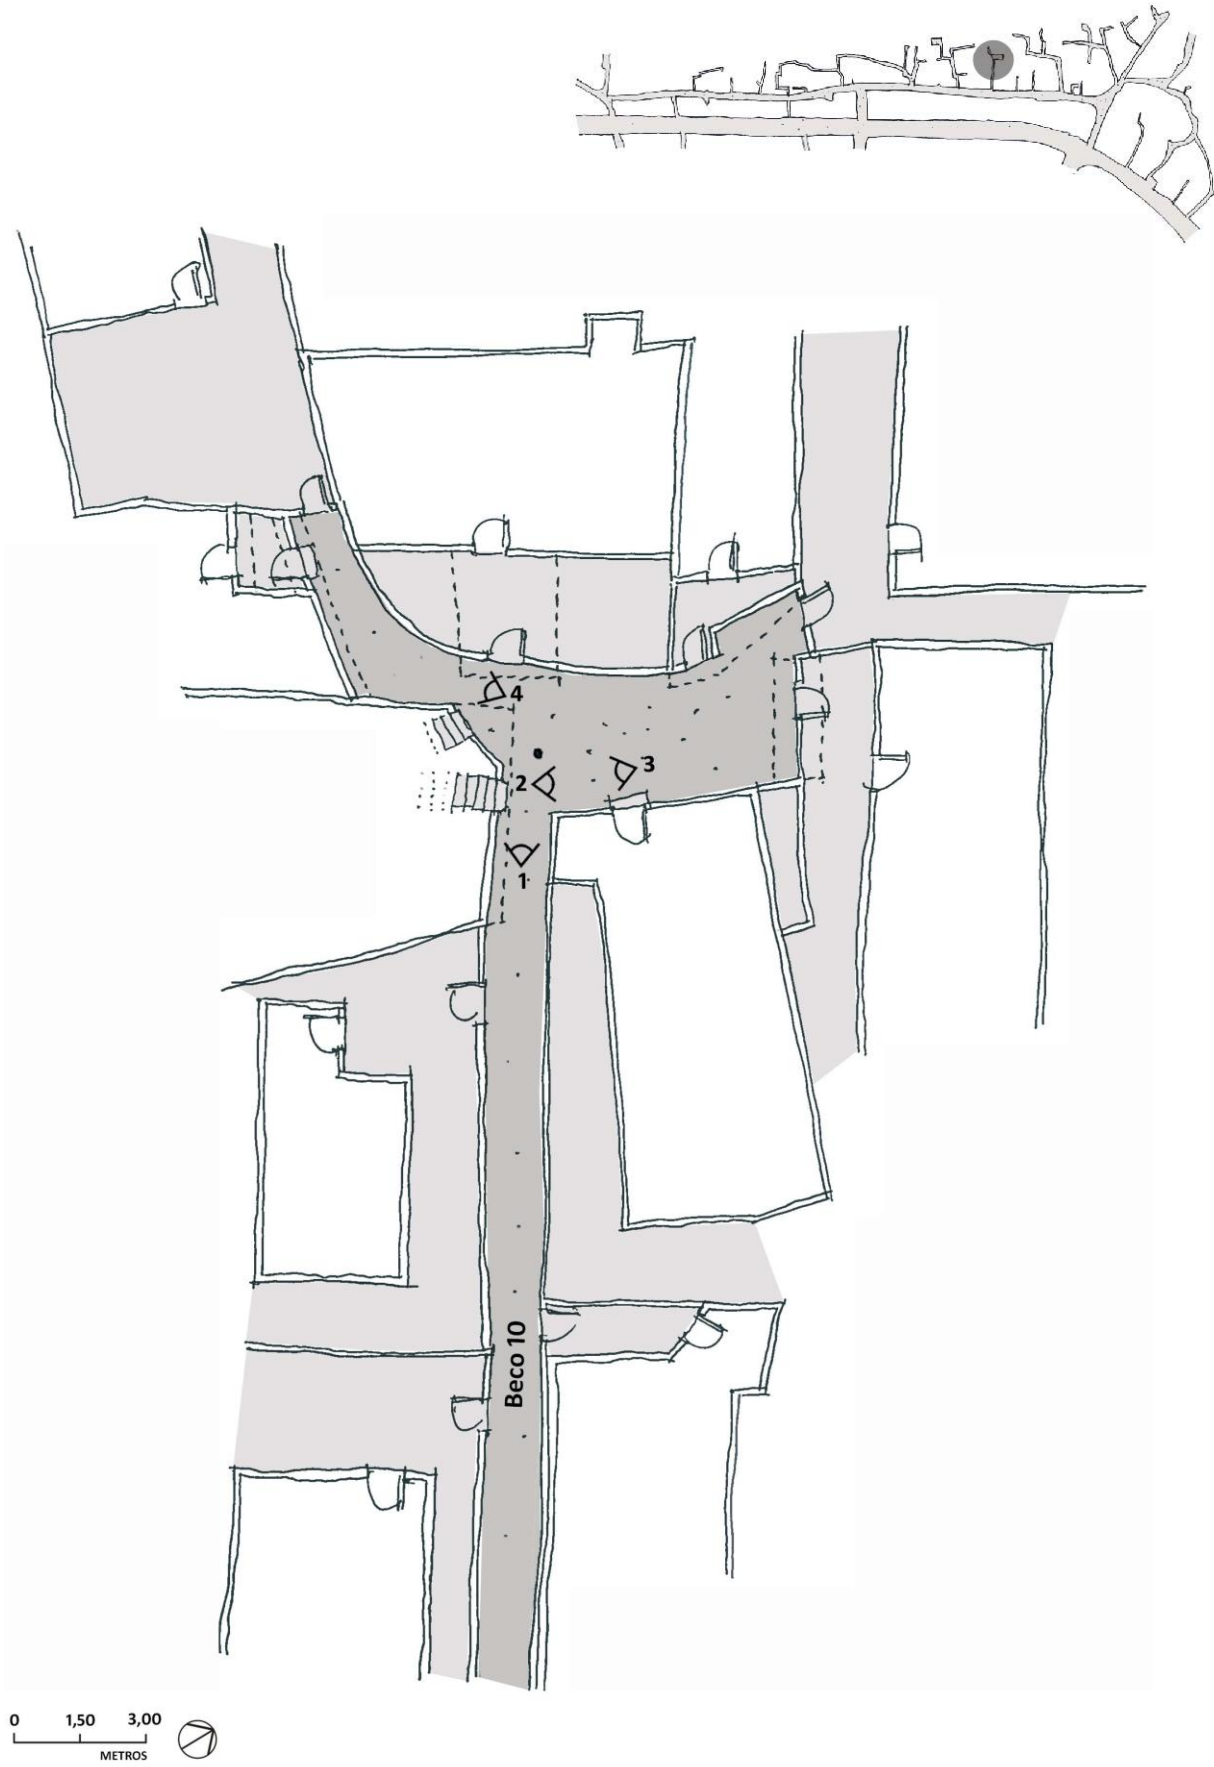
Localização. Figura 2.29 Representação em planta. Fonte: Autora.
